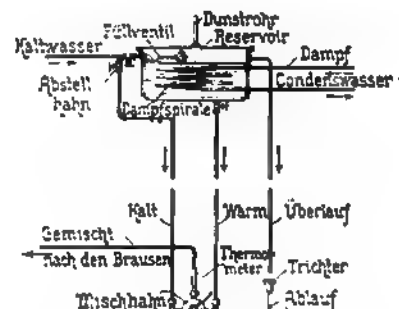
Schema einer Badeeinrichtung mit Warmwasserreservoir u. Dampfheizschlange
